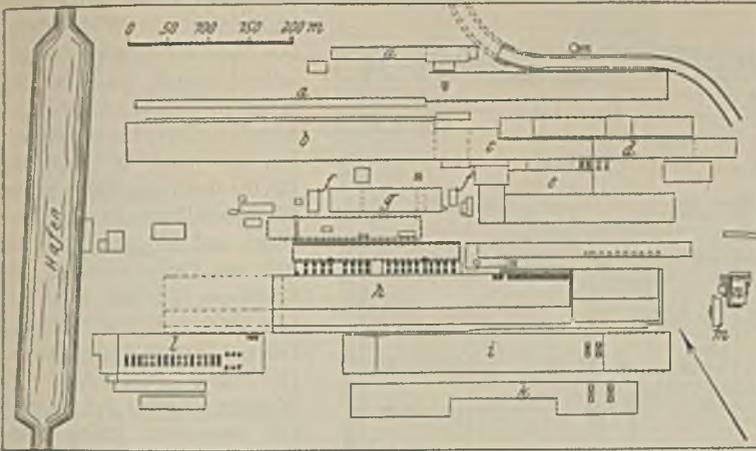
Lageplan der Walzwerke der Inland Steel Company.
